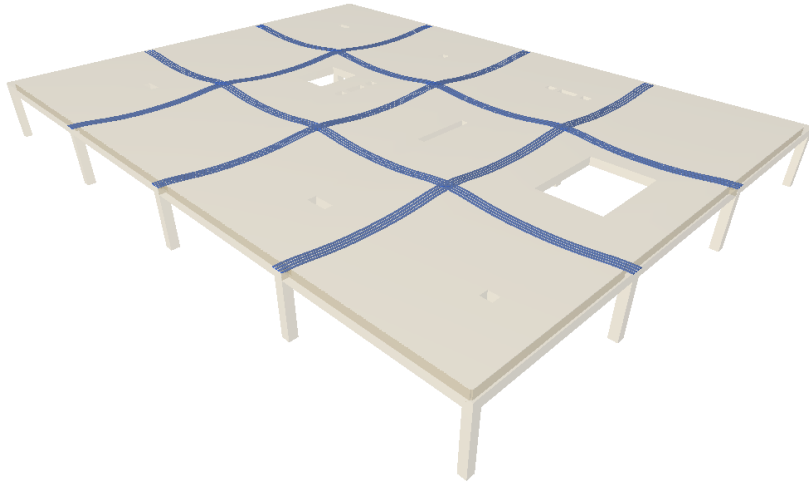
Disposición de tendones concentrados sobre pilares en ambas direcciones
